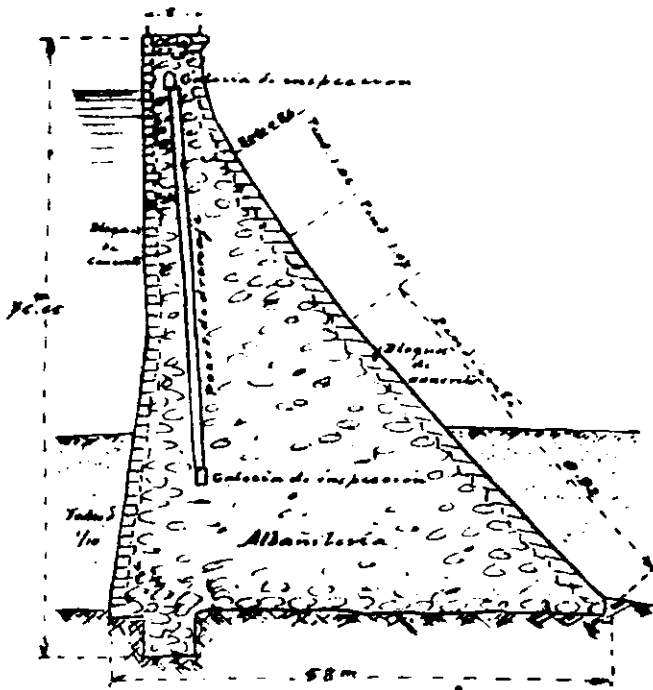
Corte transversal de la parte de albañilería del tranque de Ashokan.
